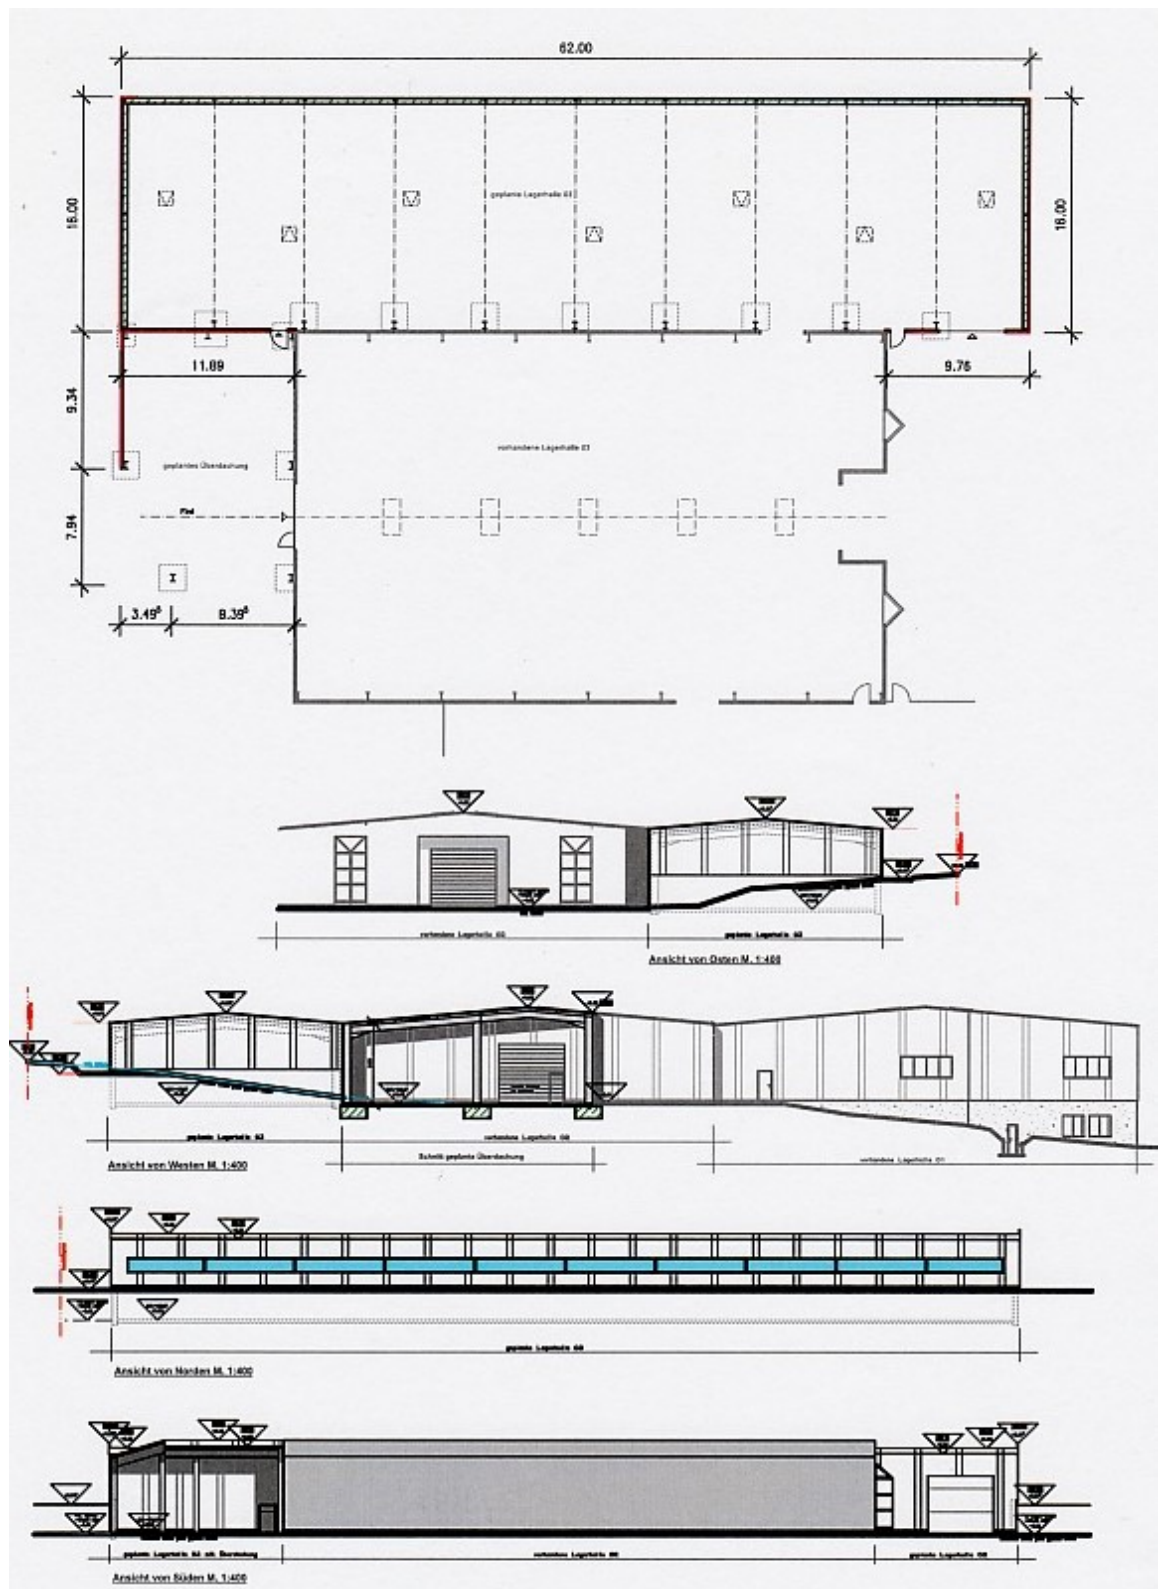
Grundriss, Ansichten und Schnitte der geplanten Halle 03
